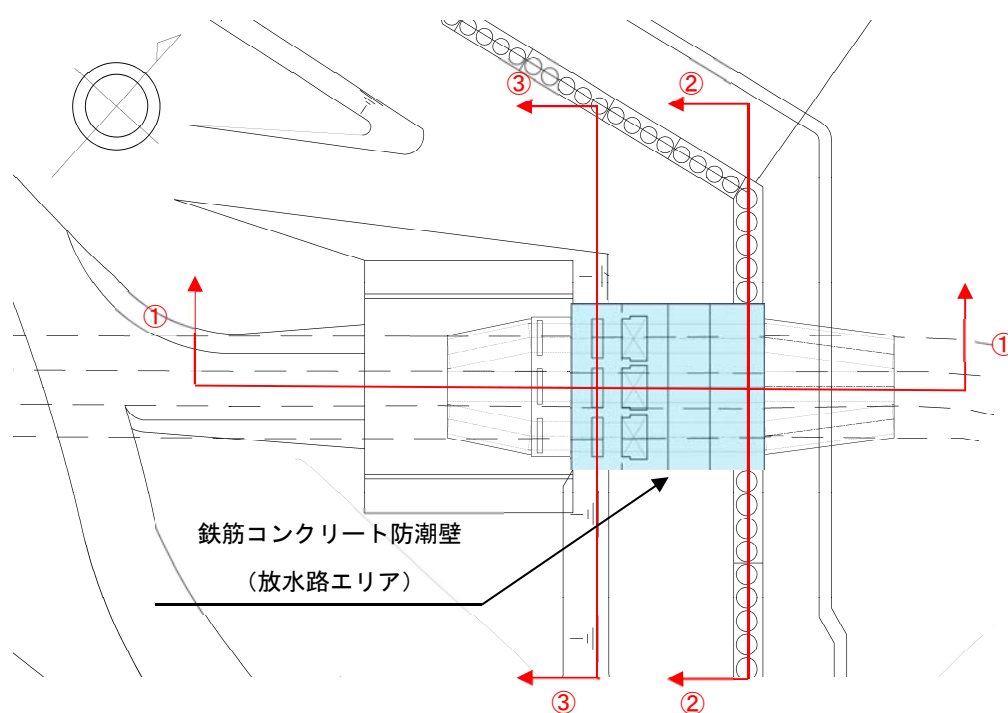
鉄筋コンクリート防潮壁（放水路エリア）の平面図
